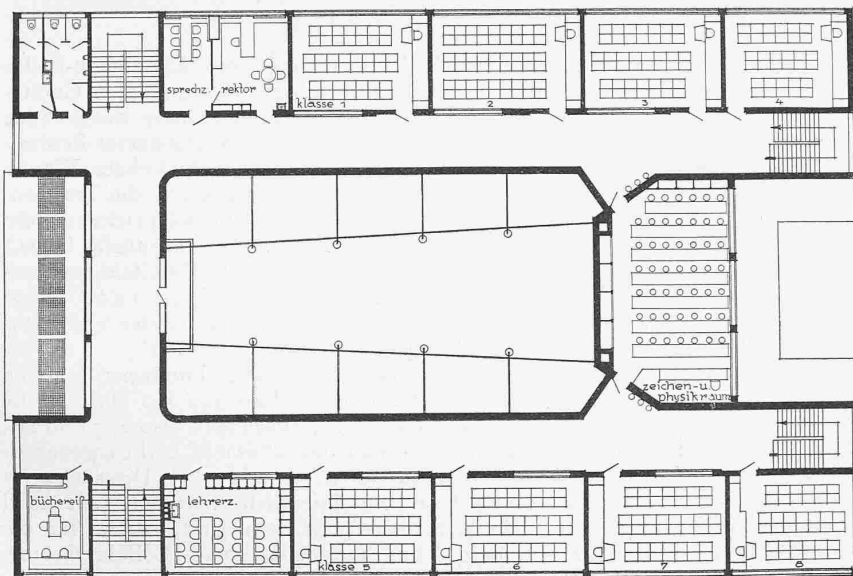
Obergeschoss-Grundriss. — Masstab 1 : 400.
